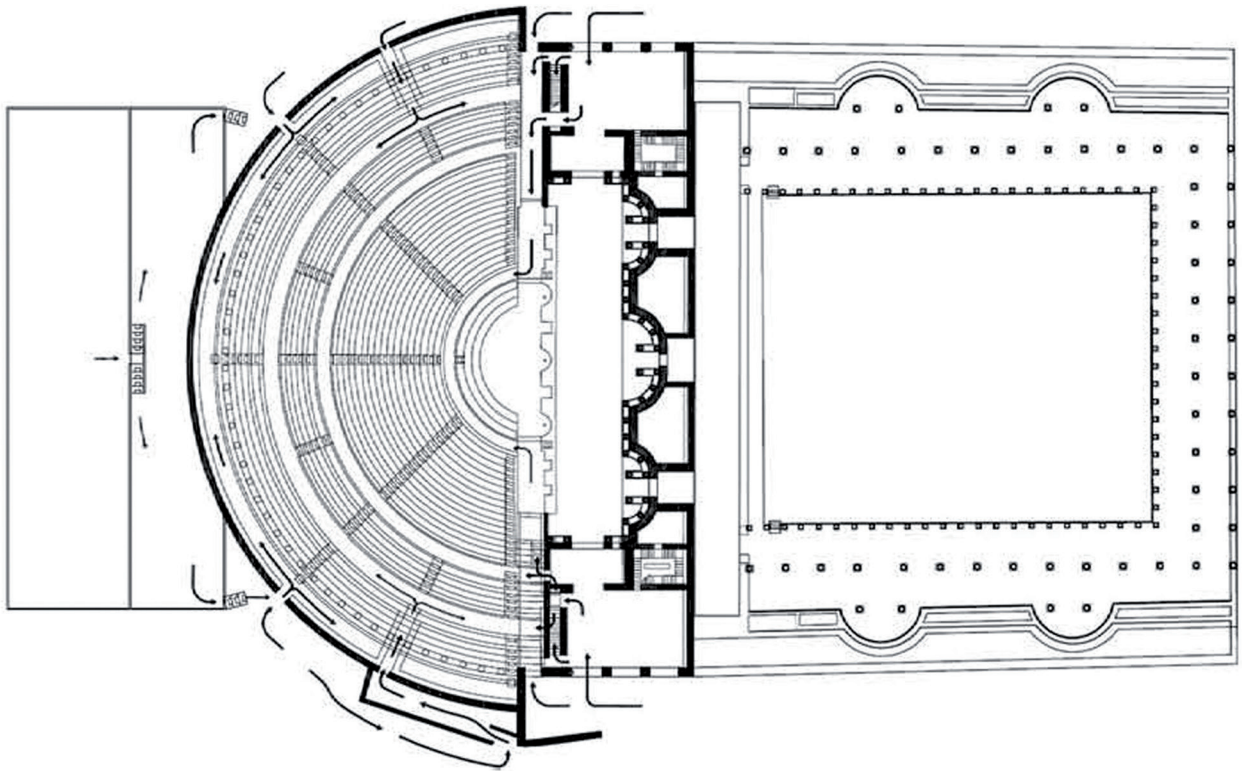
Planta general del teatro (Fundación teatro romano) (arriba);
